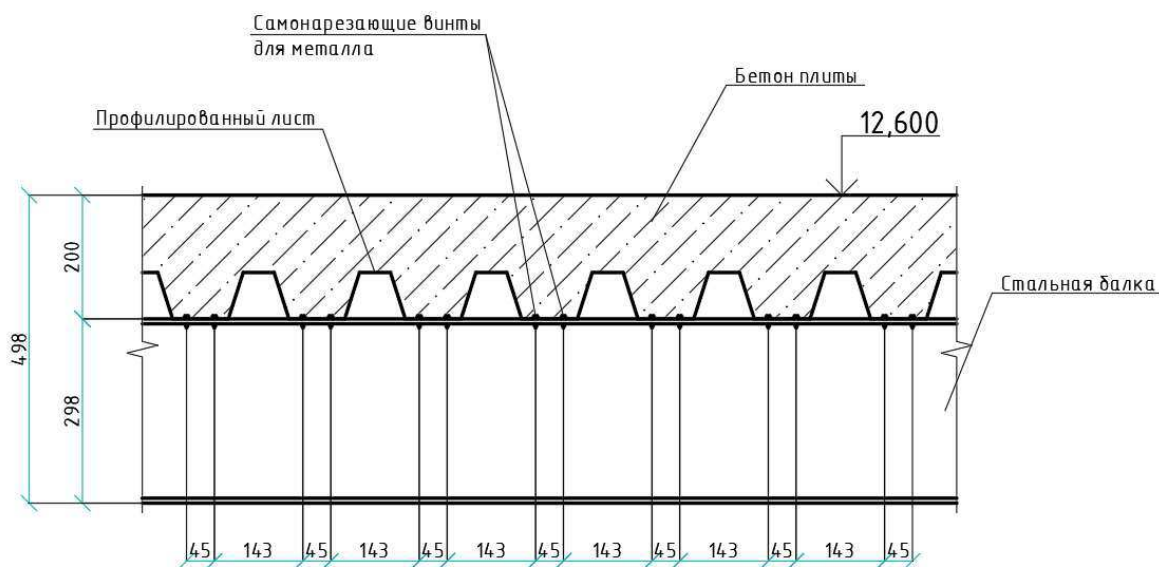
Конструкция сталежелезобетонного перекрытия (вариант 2)
